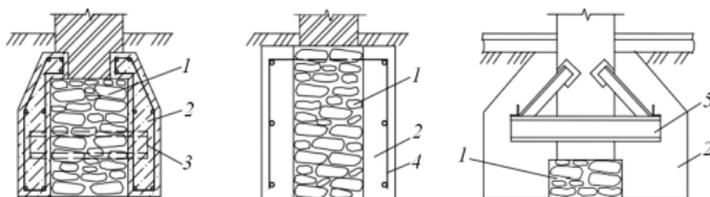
Варианты усиления бутовых фундаментов обоймами: а – с креплением их балками и штрабами; б – арматурными элементами; в – жестким металлическим каркасом; 1 – существующий фундамент; 2 – обойма усиления; 3 – металлическая балка; 4 – арматурные стержни; 5 – металлический каркас.
